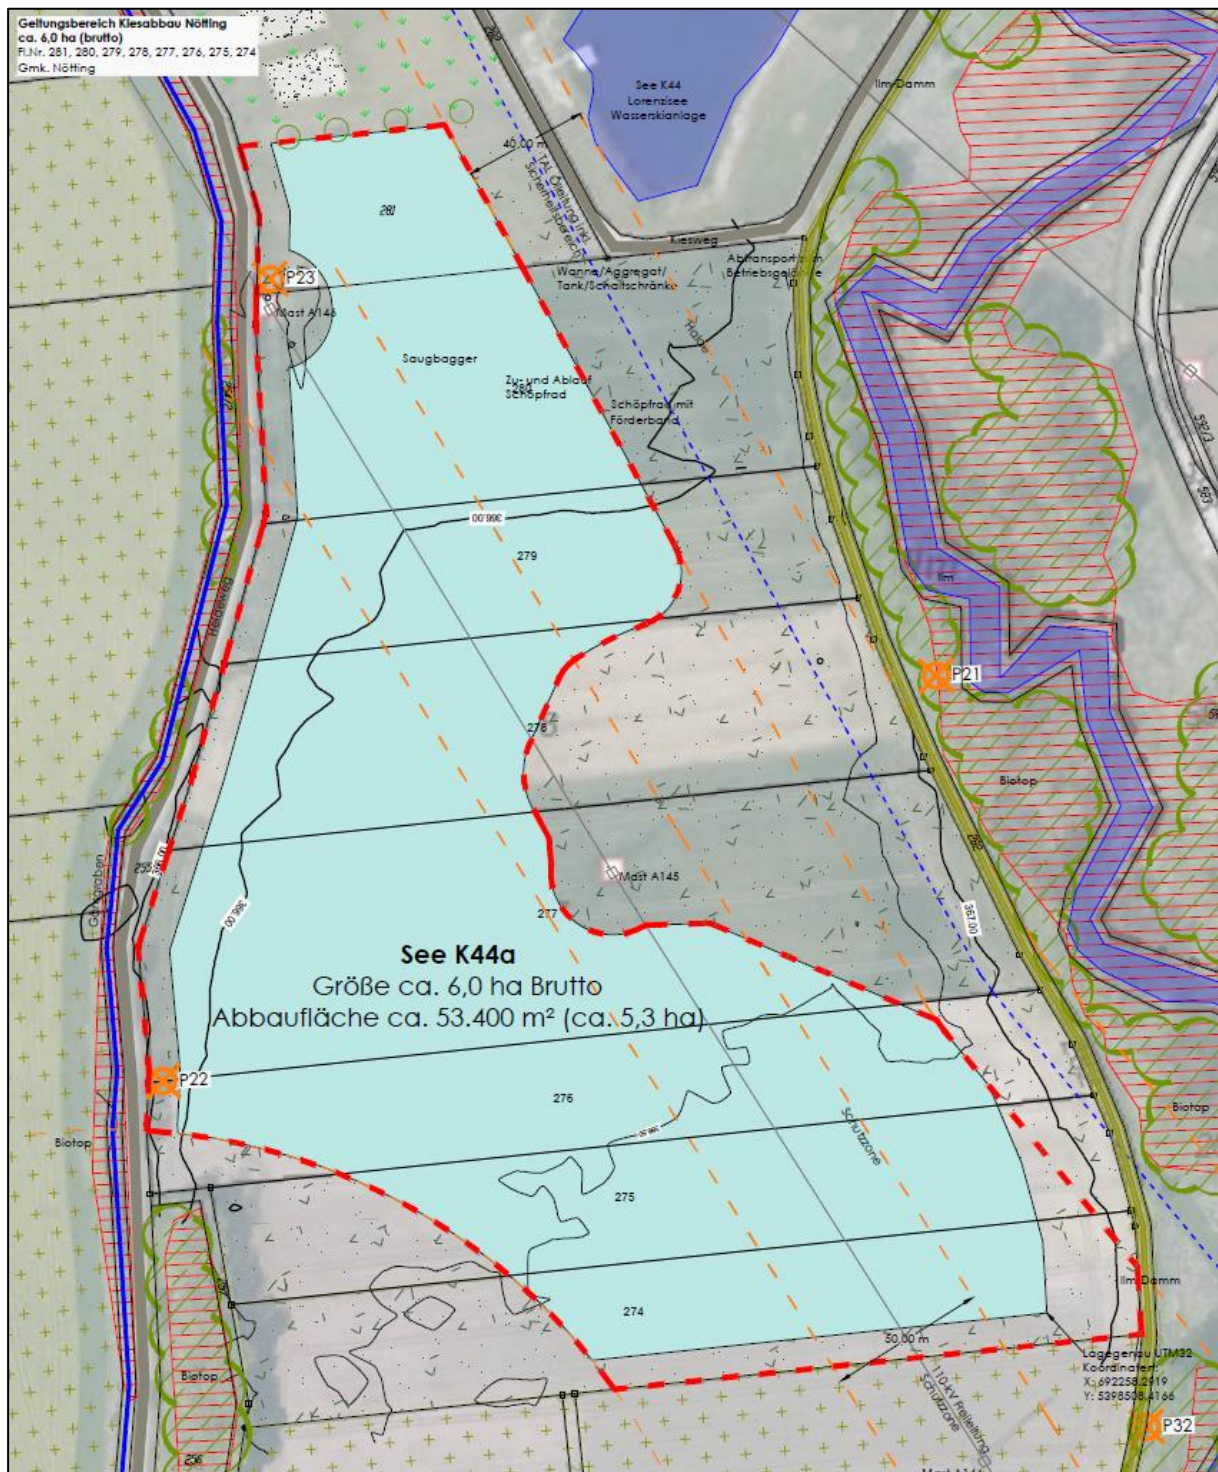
Lageplan⁷ zum geplanten Nass-Kiesabbau zwischen Lorenzisee und dem Ort Nötting;
